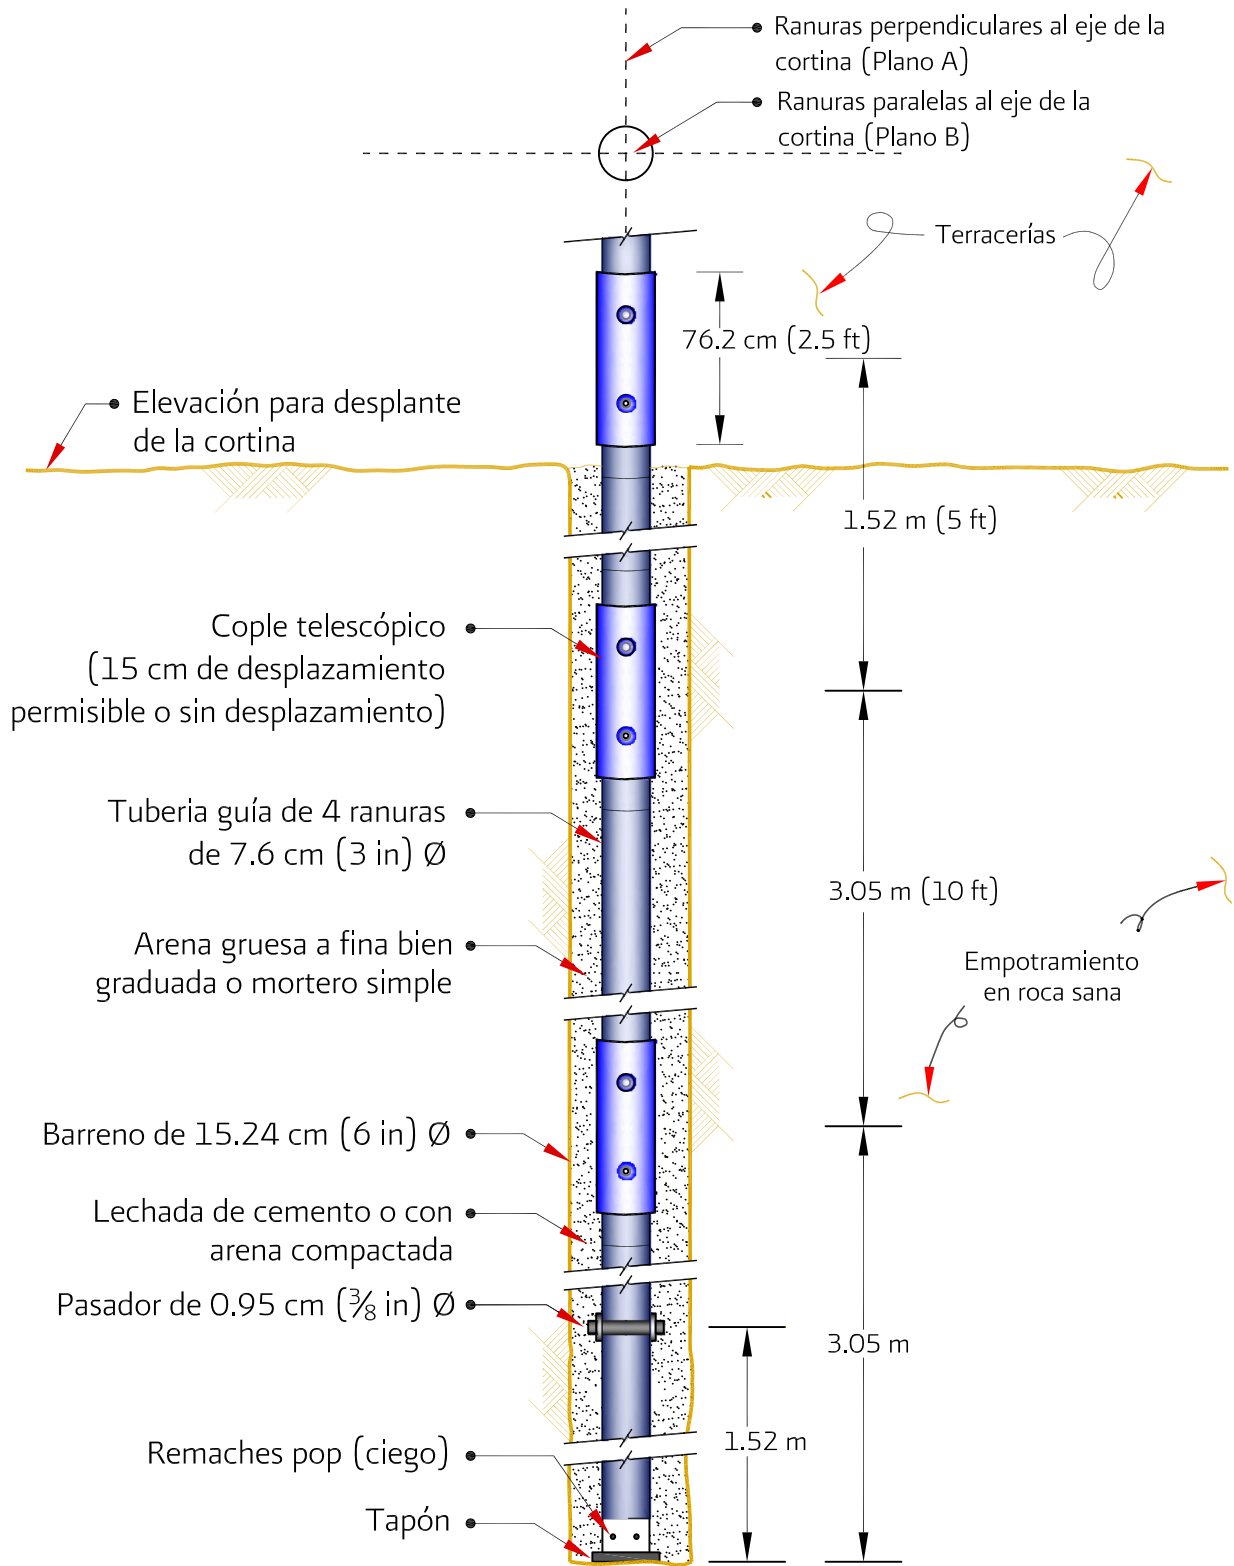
Detalle de anclaje de la tubería guía del inclinómetro en su extremo inferior
